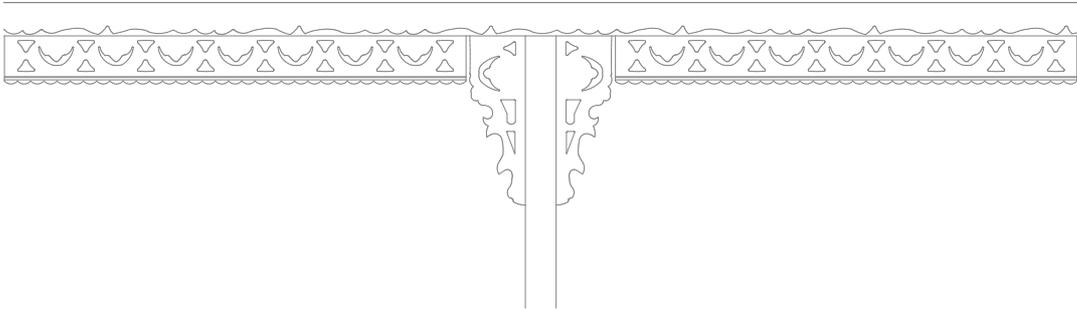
Wohnhaus, Detailzeichnung prispä
